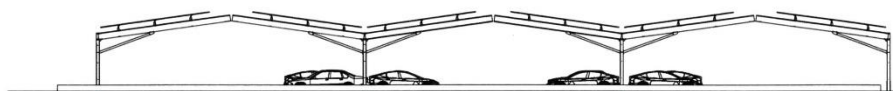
Dakaanzicht Solar Parking 'De Kuil'
